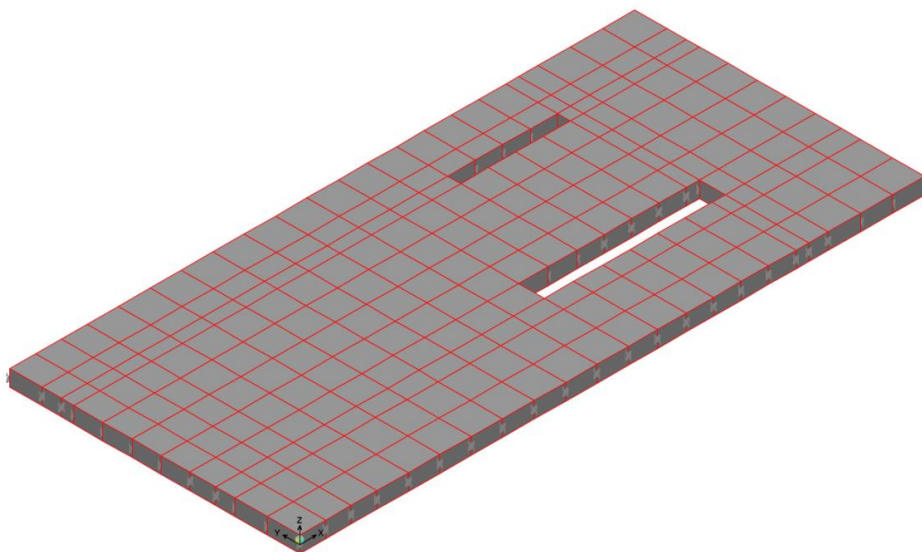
Schema Fili Fissi Basamento PPT
